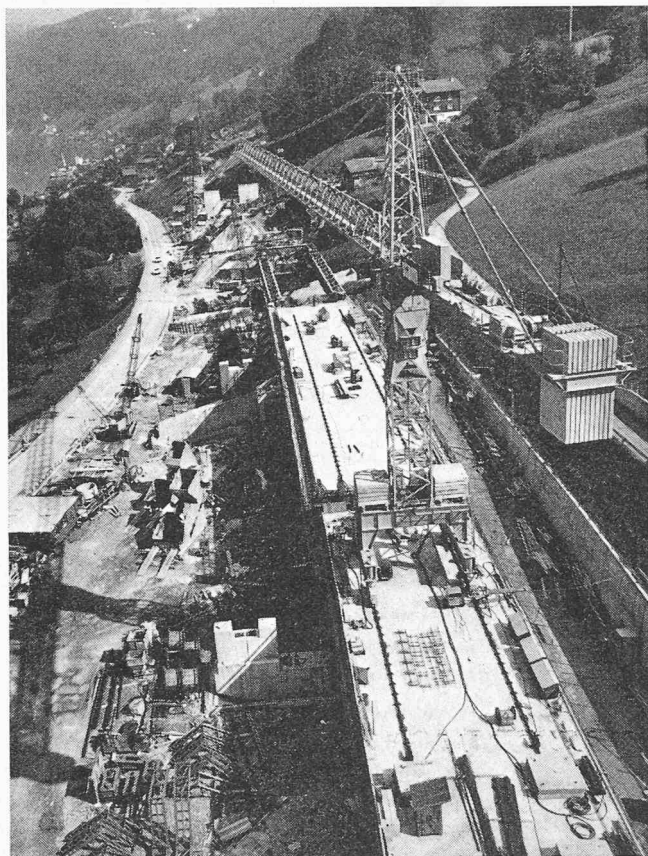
Sicht über die ersten drei erstellten Felder der bergseitigen Brücke und über die Pfeiler- und Schachtbaustellen bis zum Portal des Seelisbergtunnels, das die Brücke im Oktober 1980 erreichen soll (Aufnahme: A. Odermatt, 10. 9. 1977)
